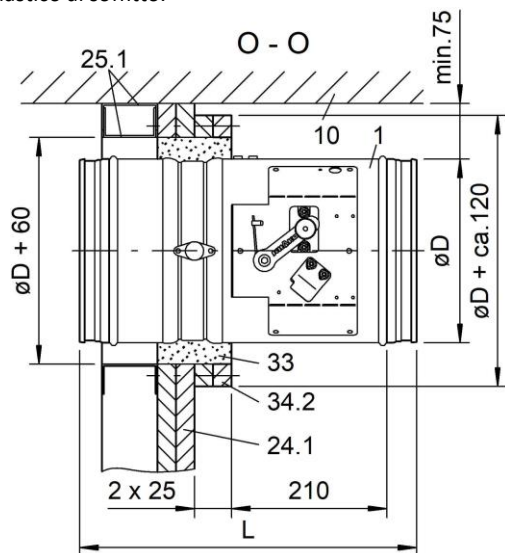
montaggio a umido in pareti pozzetto sotto soffitti massicci (BSK-RPR da 100 a ≤ 250)
